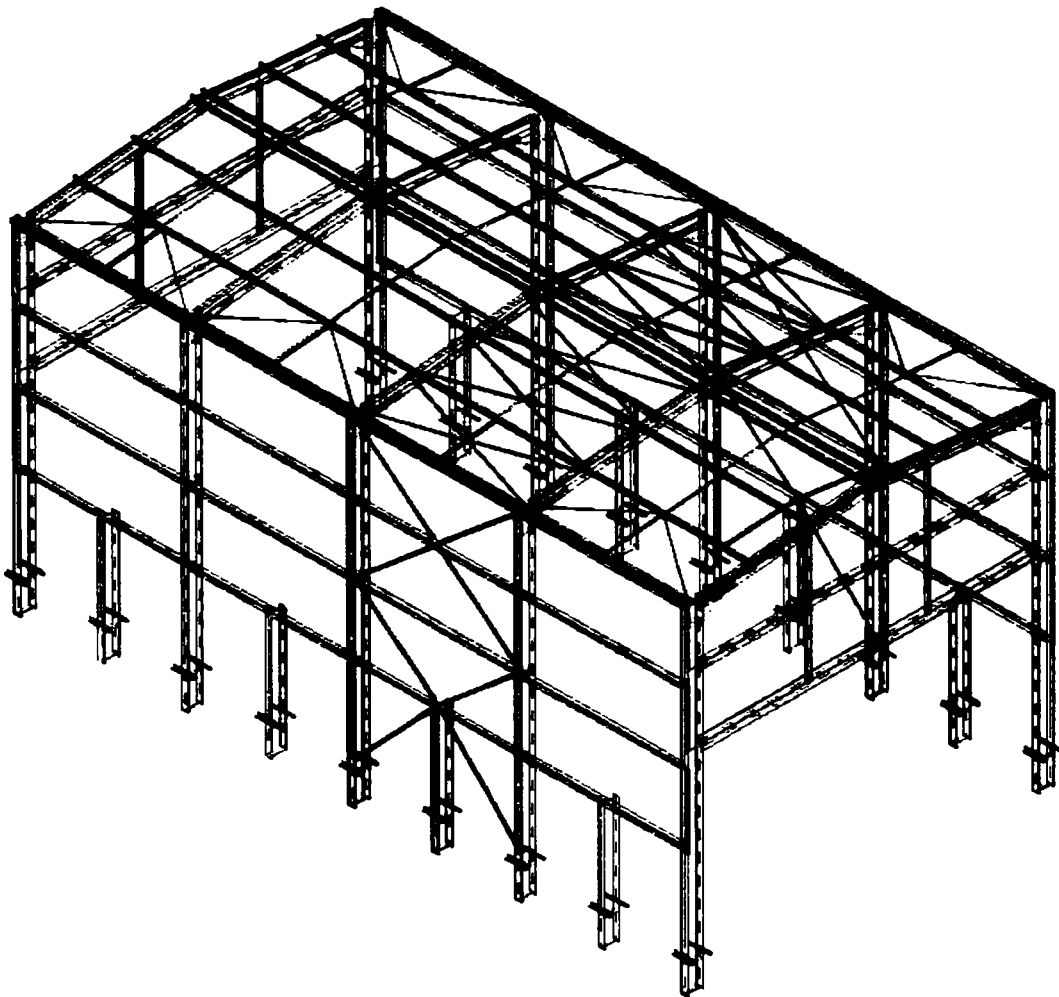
Hală metalică industrială optimizată în vedere izometrică
